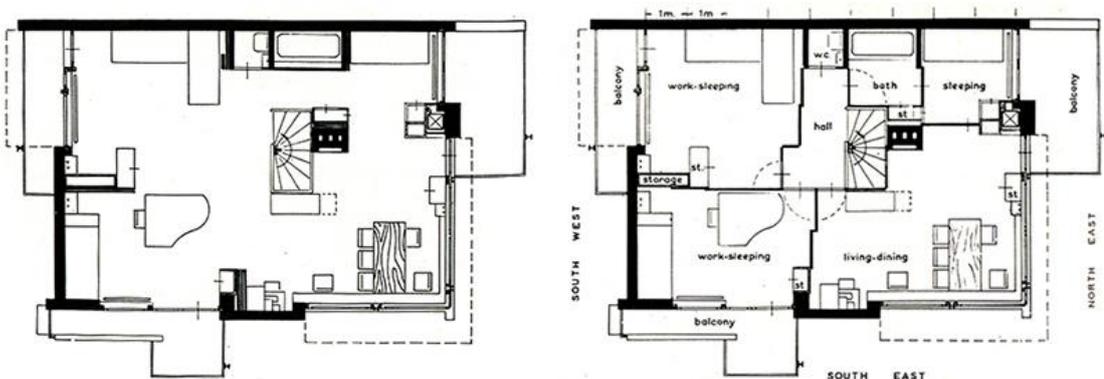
Planta Superior abierta y cerrada. Casa Schröder
